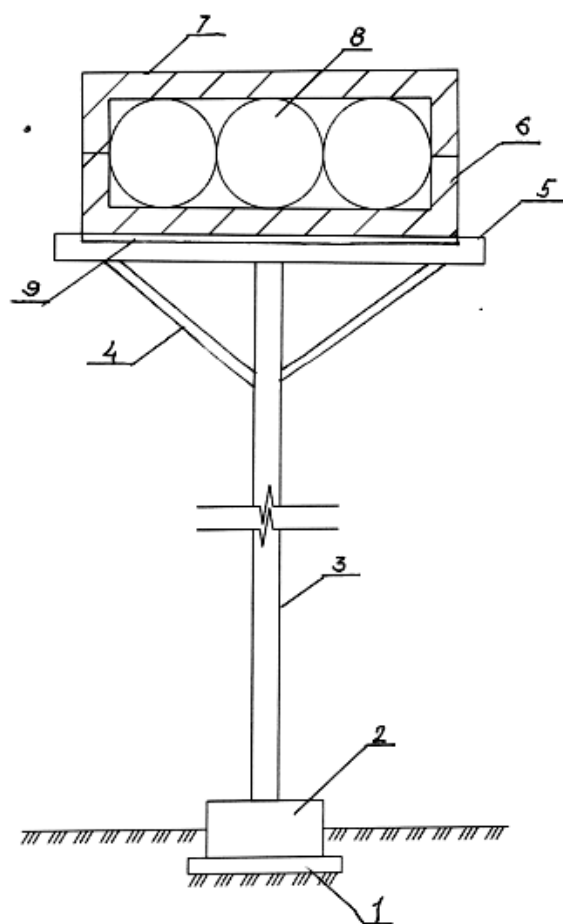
Схема теплоизоляции теплотрасс воздушной прокладки
